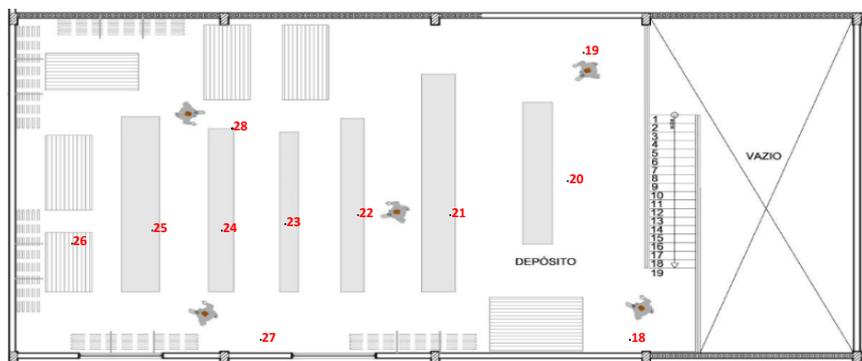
Planta baixa do almoxarifado no pavimento térreo
